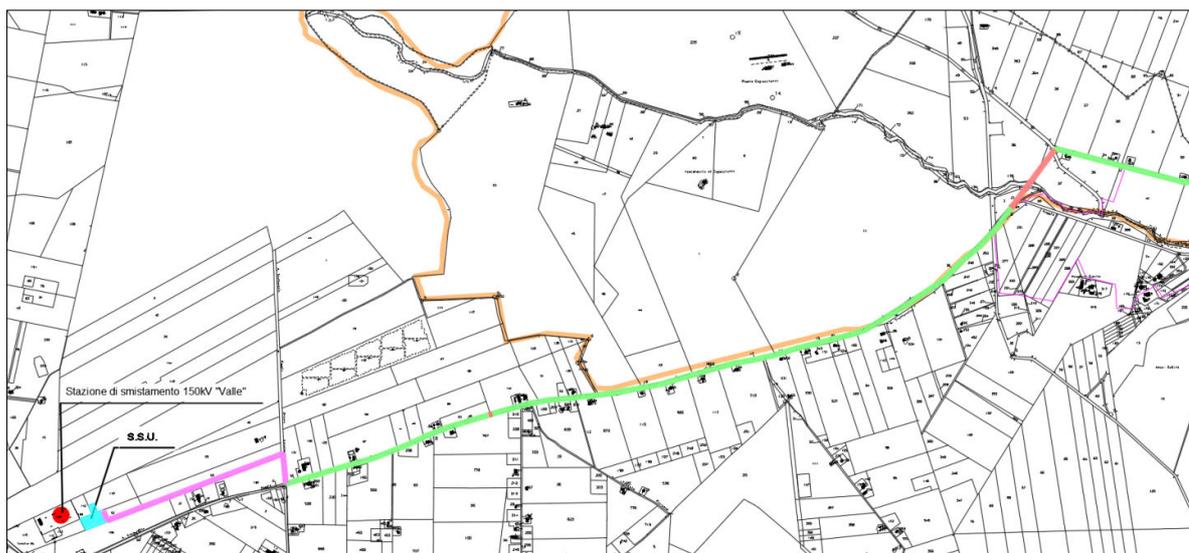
Stralcio 3 da planimetria catastale - percorso cavidotto MT
